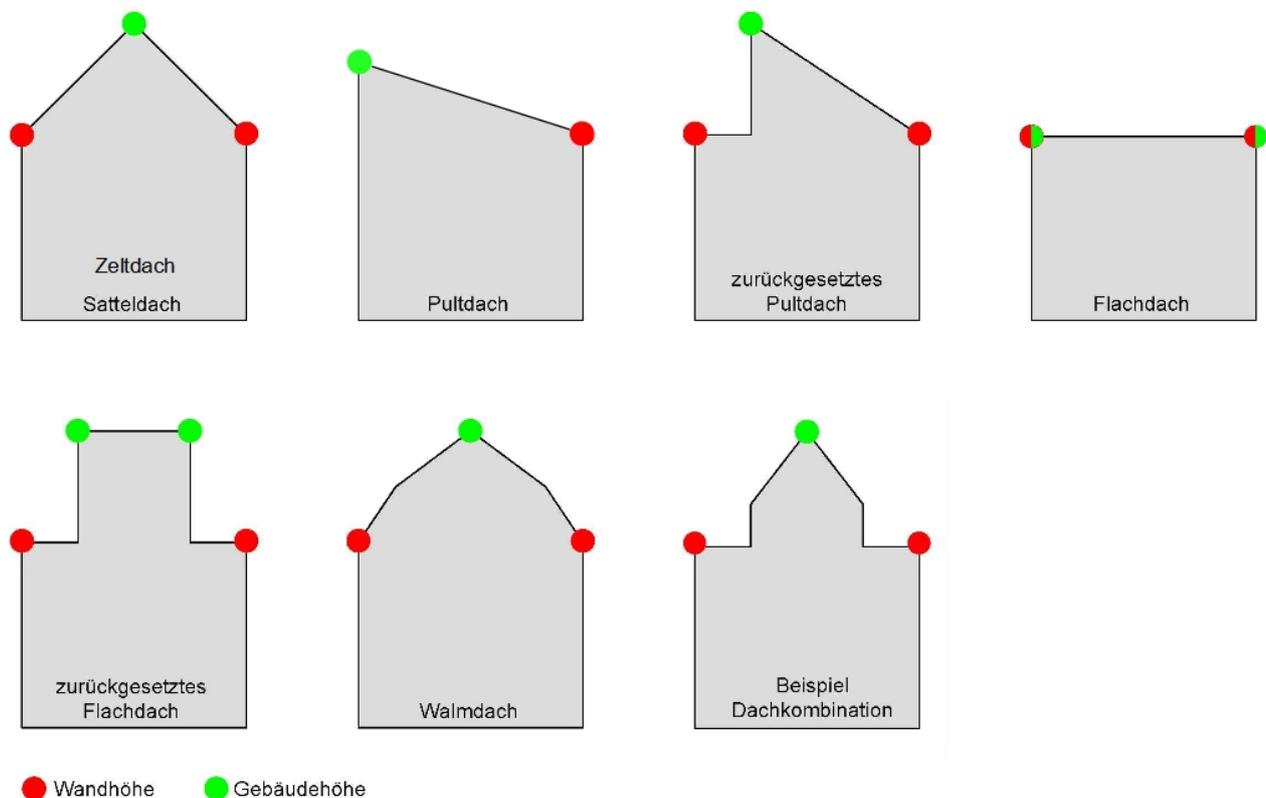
Differenzierte Höhenfestsetzungen je nach Dachform
